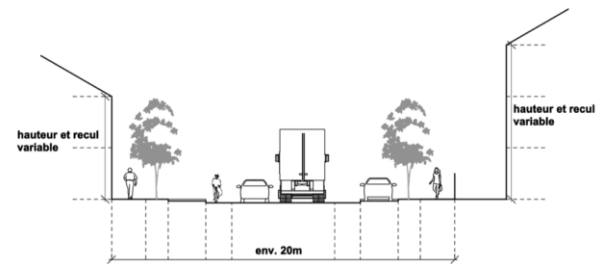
Avenue d'entrée de ville XIXème, ex : Avenue de Quackenbrück
